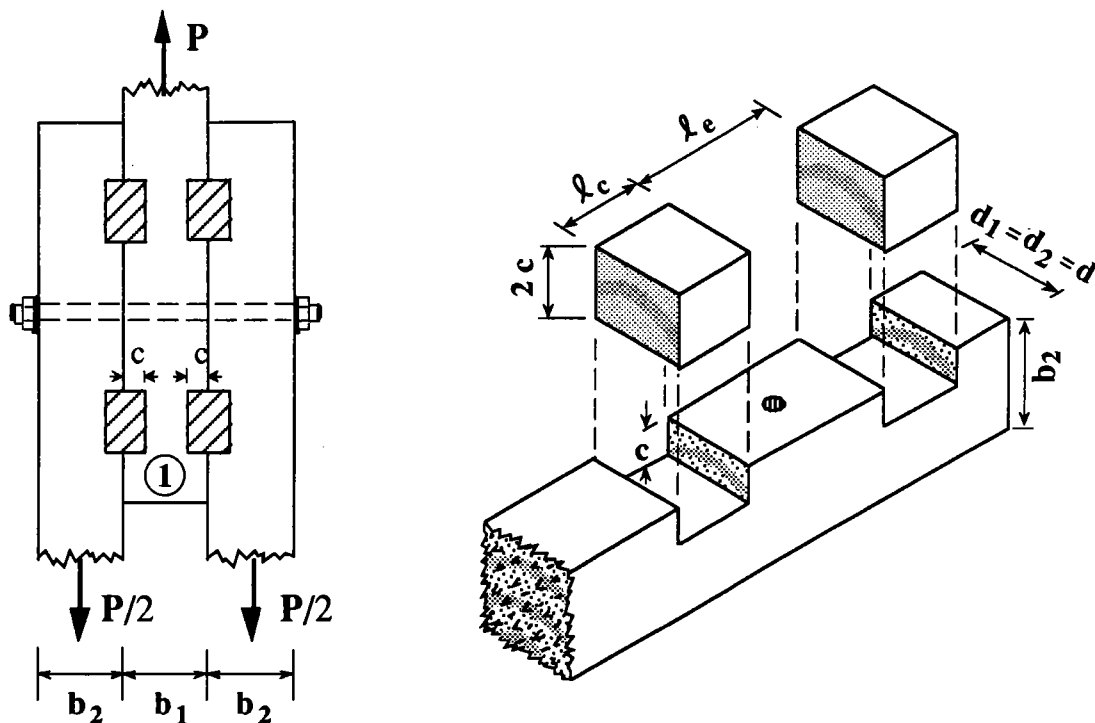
Exemple d'assemblage à clavette de bois dur.
